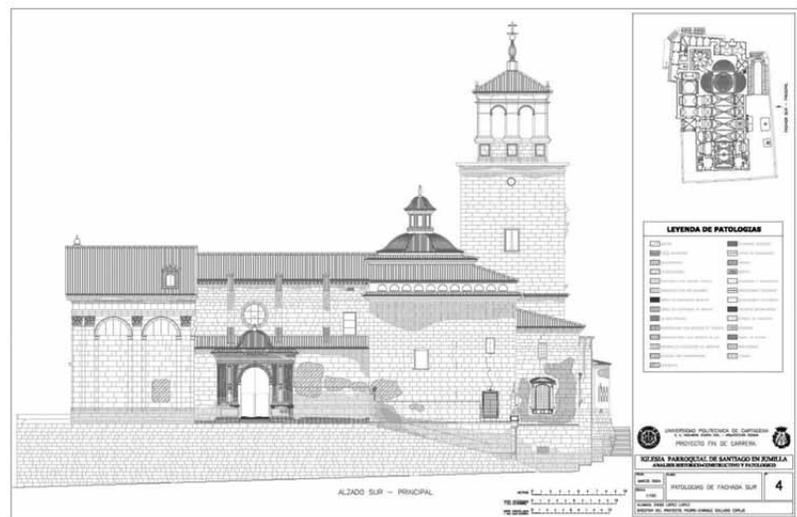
Plano de patologías existentes en la fachada sur de la iglesia.
